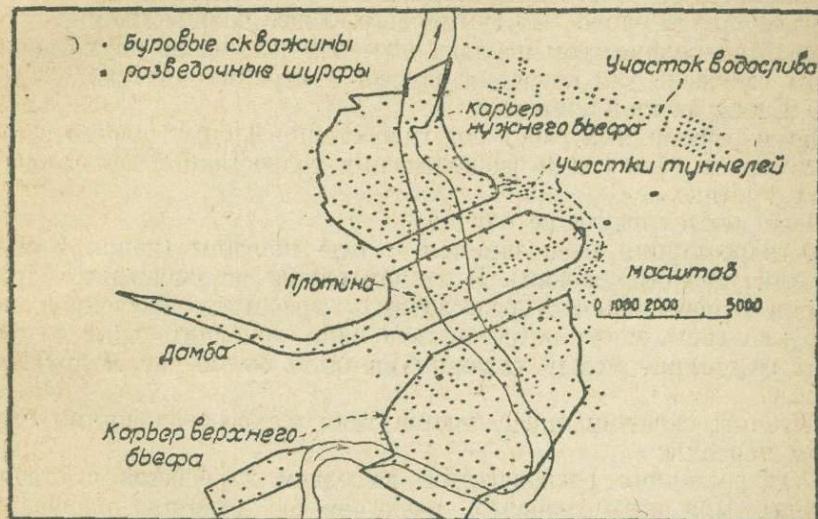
План расположения разведочных выработок под основание плотины, под туннели, водослив и на карьерах строительных материалов для намывной плотины „Fort Peck“.
